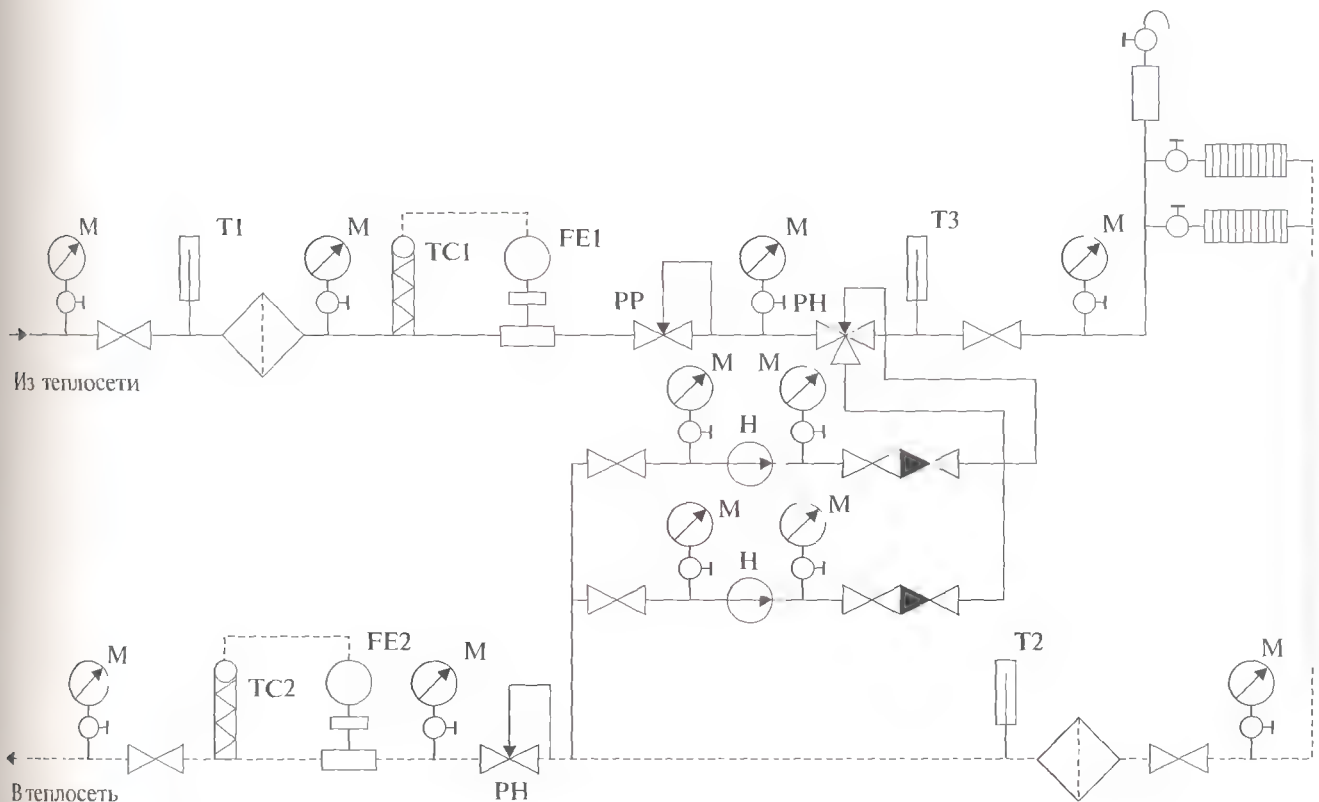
Схема теплового узла присоединения системы отопления с насосом на перемычке
